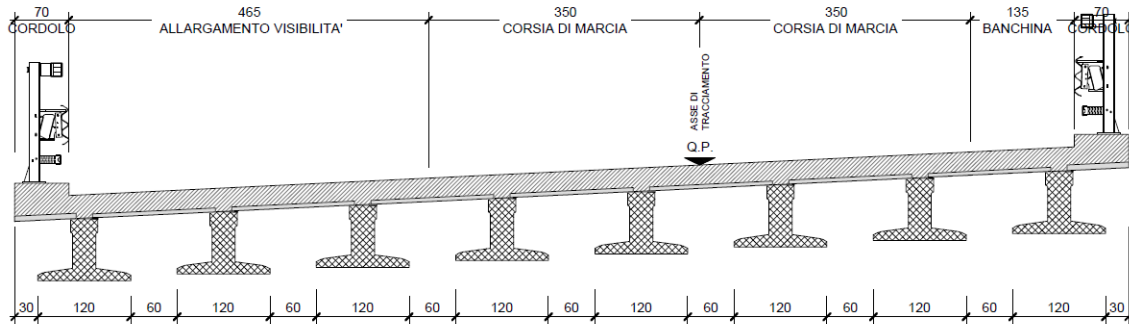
Sezione impalcato Allargamento Ponte sul Condotta Generale
